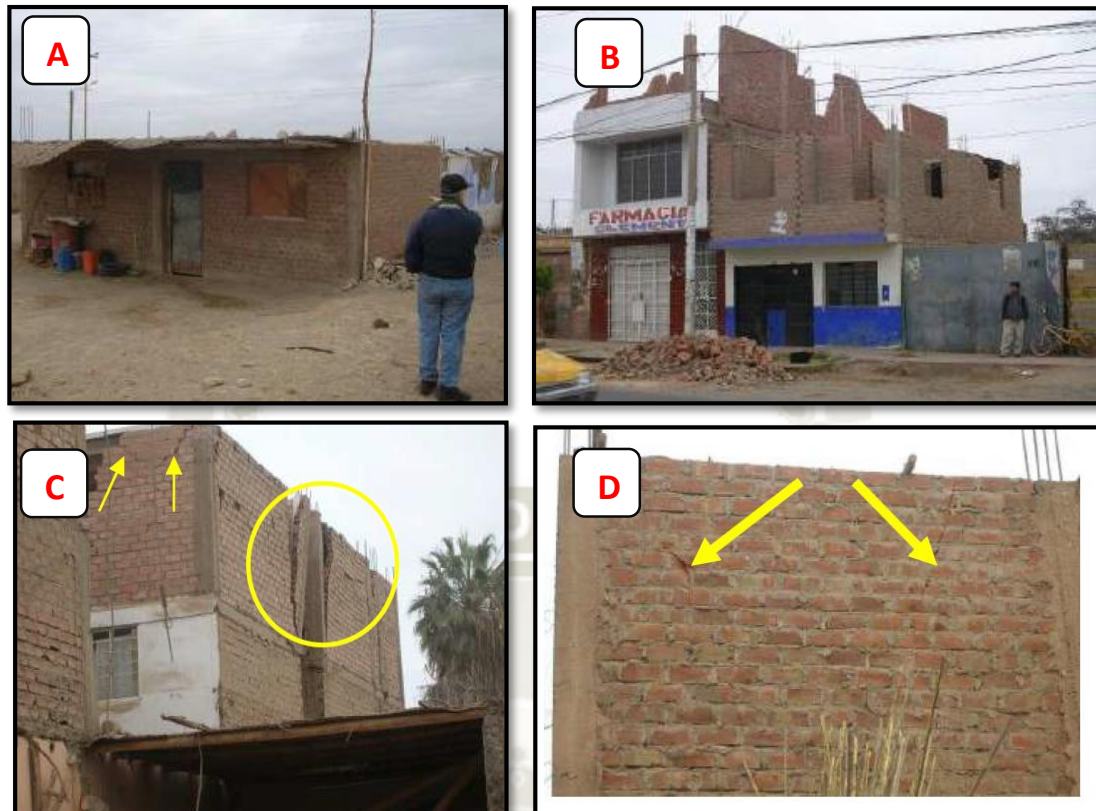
a) ejemplo de construcción por etapas. Muros y columnas construidas, falta vigas soleras y techo. b) primer piso construido, falta techar, los muros no están confinados. c) daños producidos por falta de confinamiento de vigas soleras. d) muro confinado.
